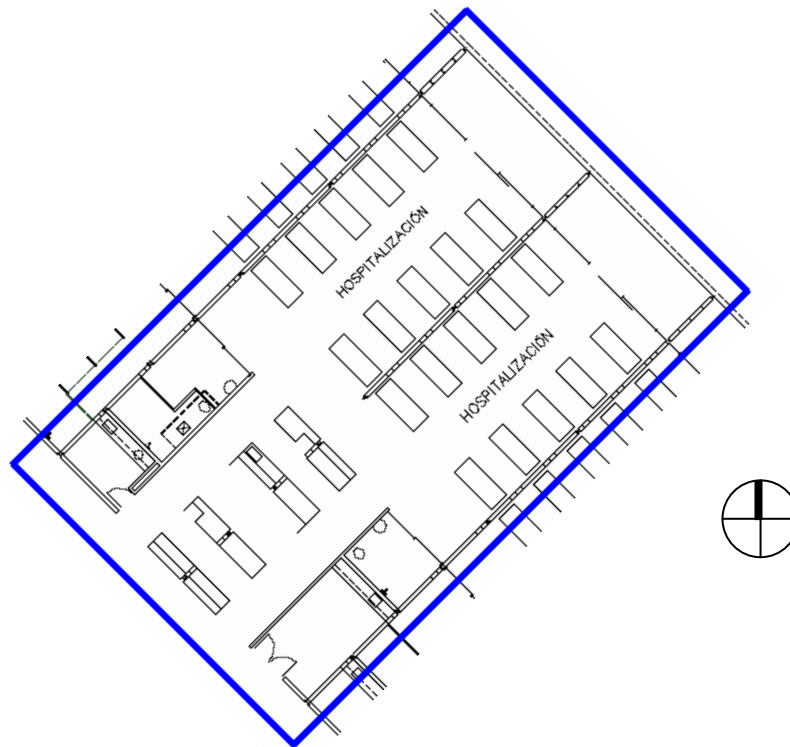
Modelo Sarah Salvador - Planta baja de hospitalización - habitación colectiva
